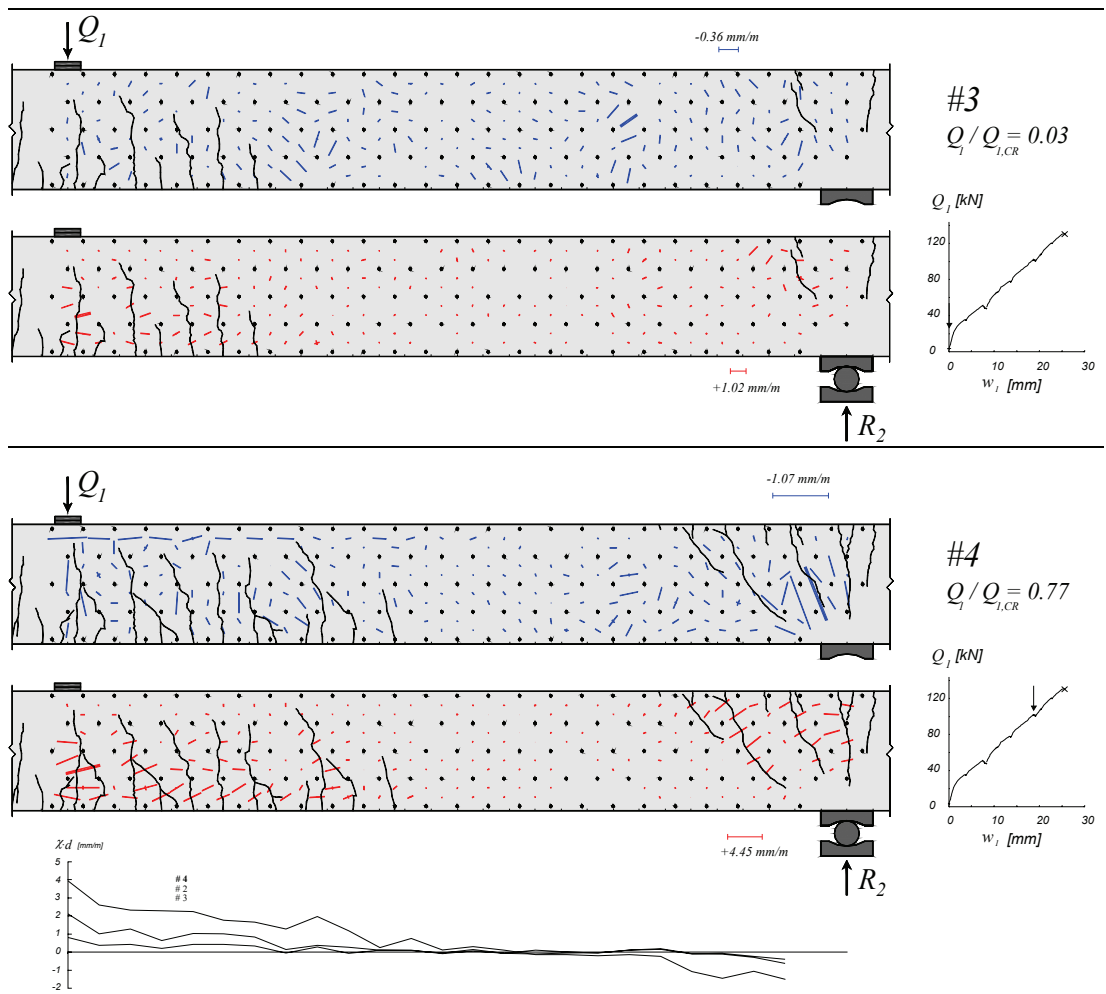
Poutre SR11: déformations principales, fissuration et courbures
